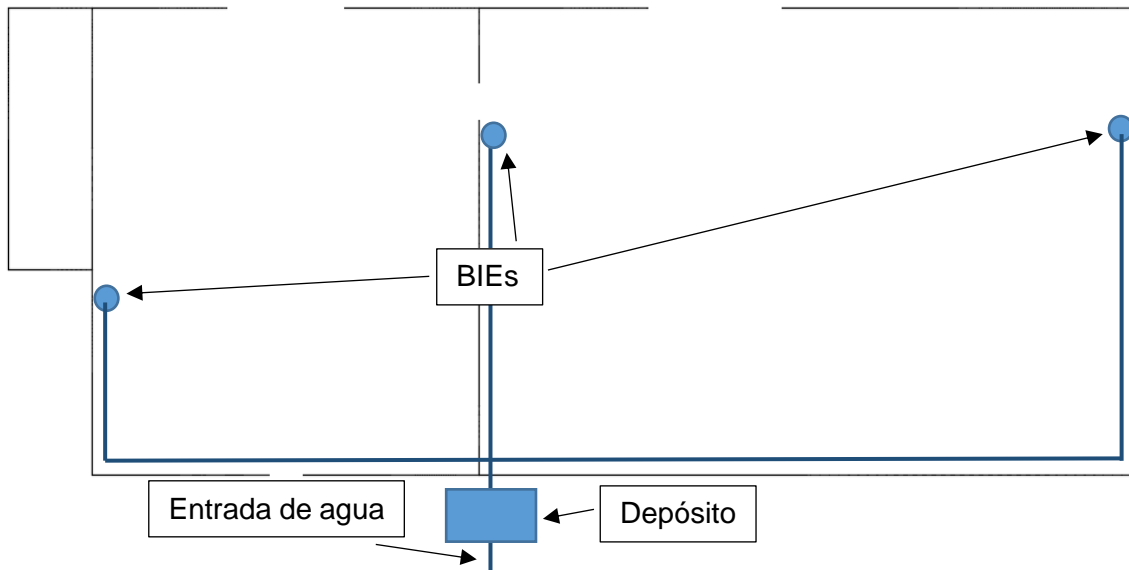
Esquema de instalación de fontanería en las naves de procesado y almacenaje
